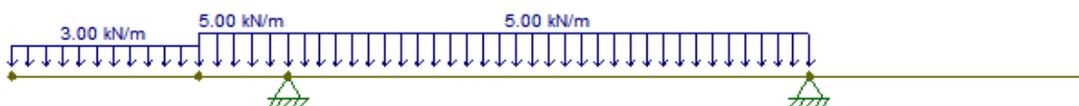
Aplicação das cargas distribuídas em um lado da estrutura
